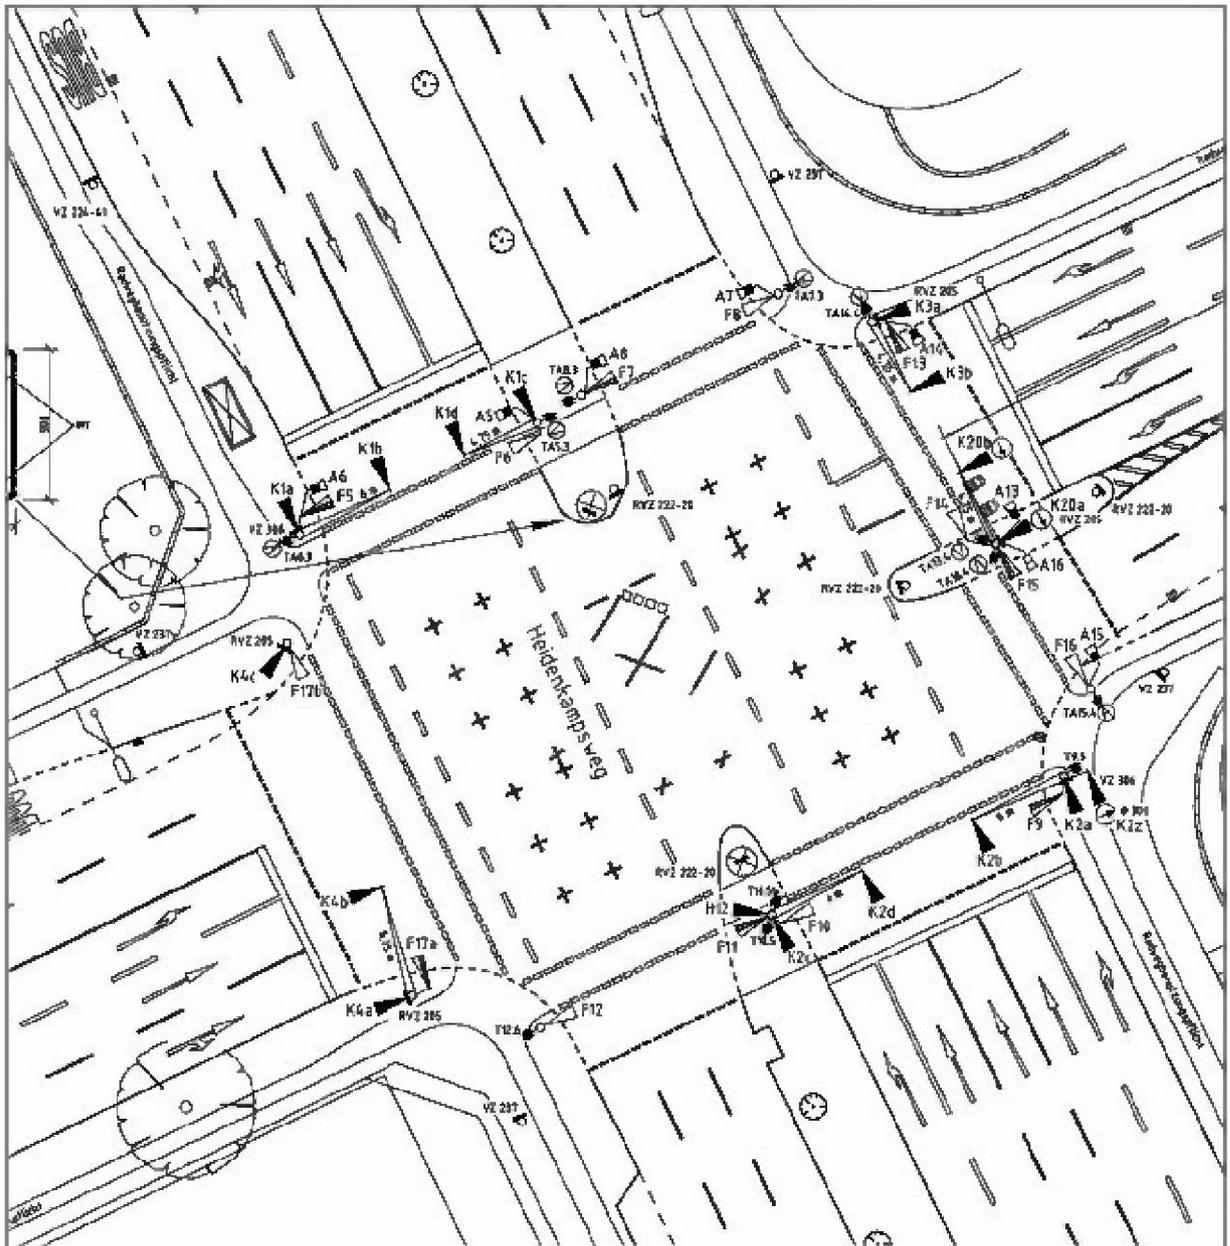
1 Signallageplanausschnitt LSA 46
